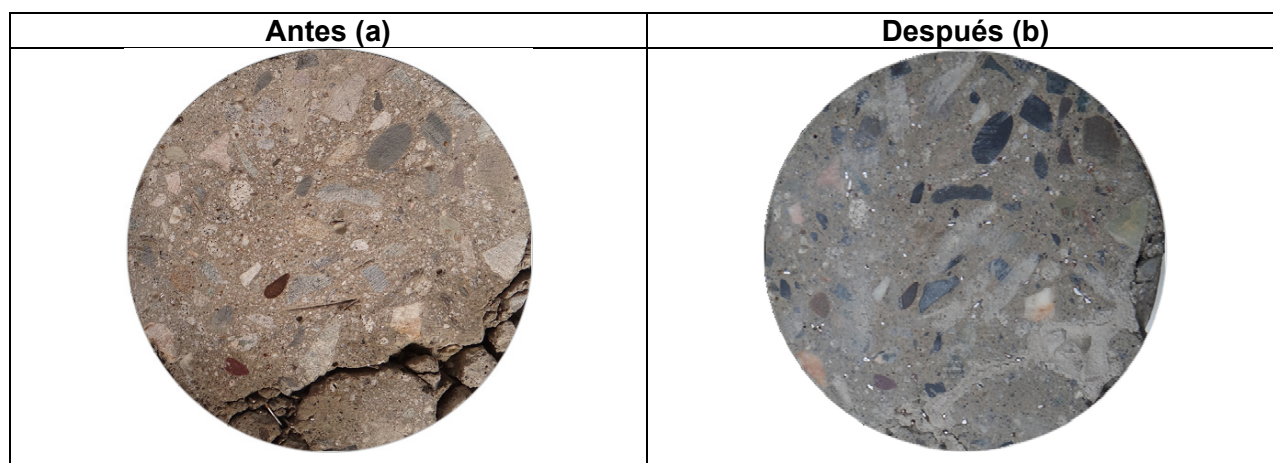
Características de concreto agrietado con medidas de mejoramiento con aditivos
